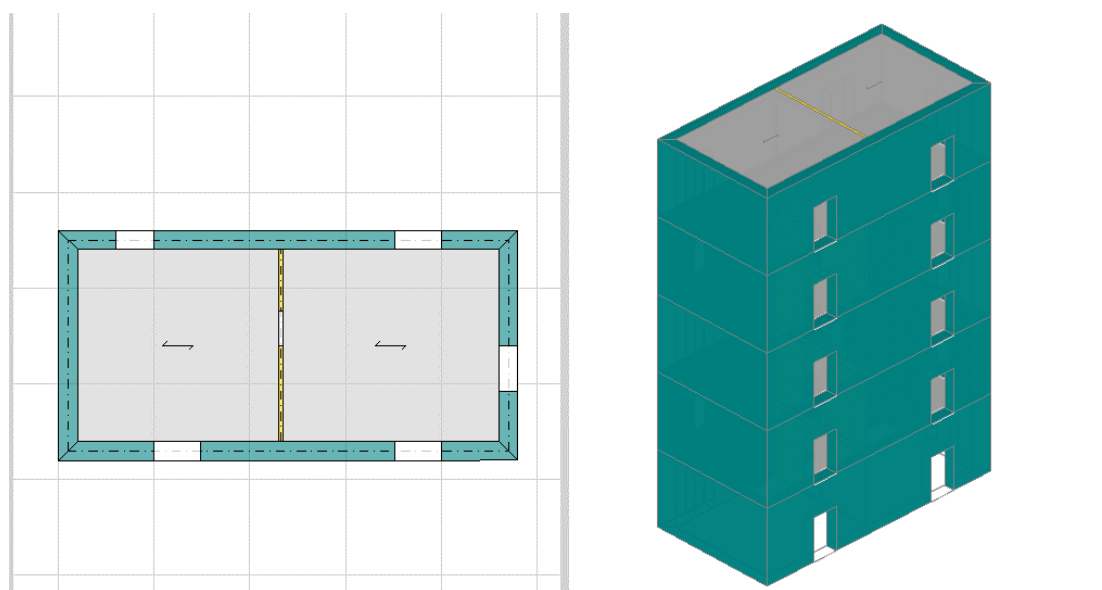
Edificio Esistente Alto: Vista in Pianta e Assonometria Sud-Ovest
